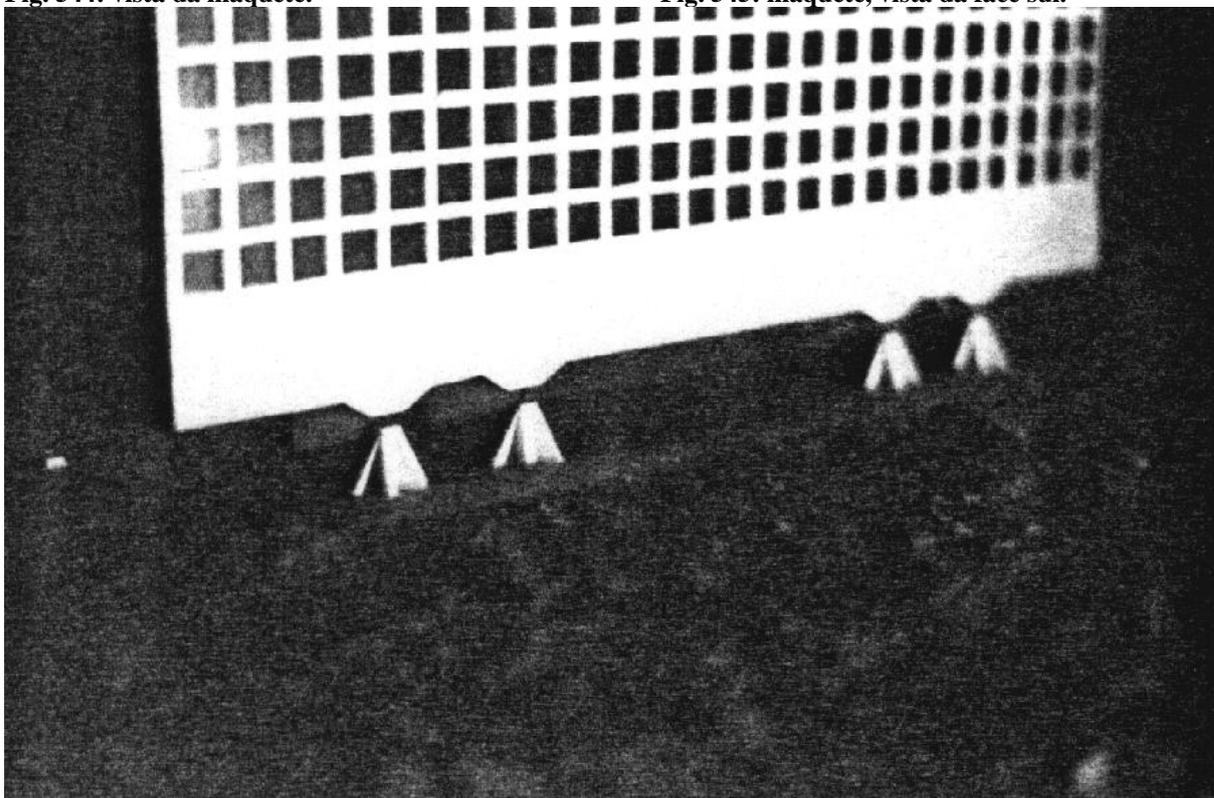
viga vierandel com quatro apoios nas fachadas maiores. Nas menores, um apoio.
